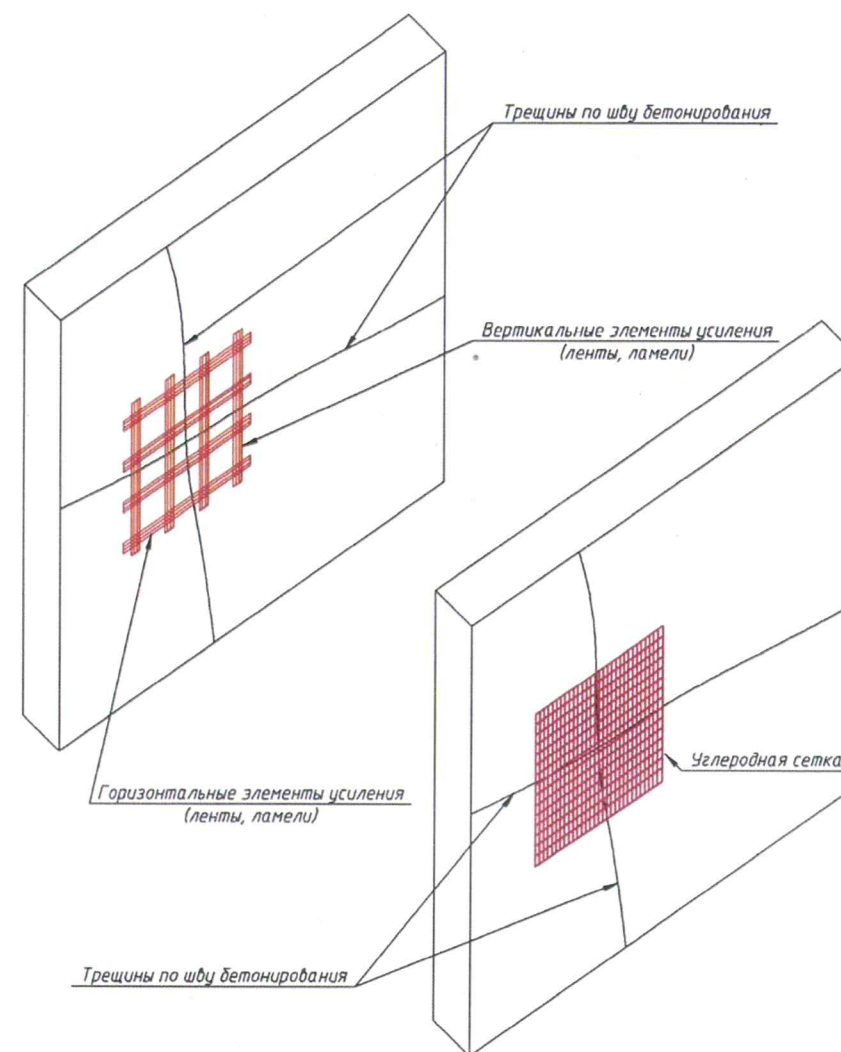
Усиление зон с трещинами (швами бетонирования)
